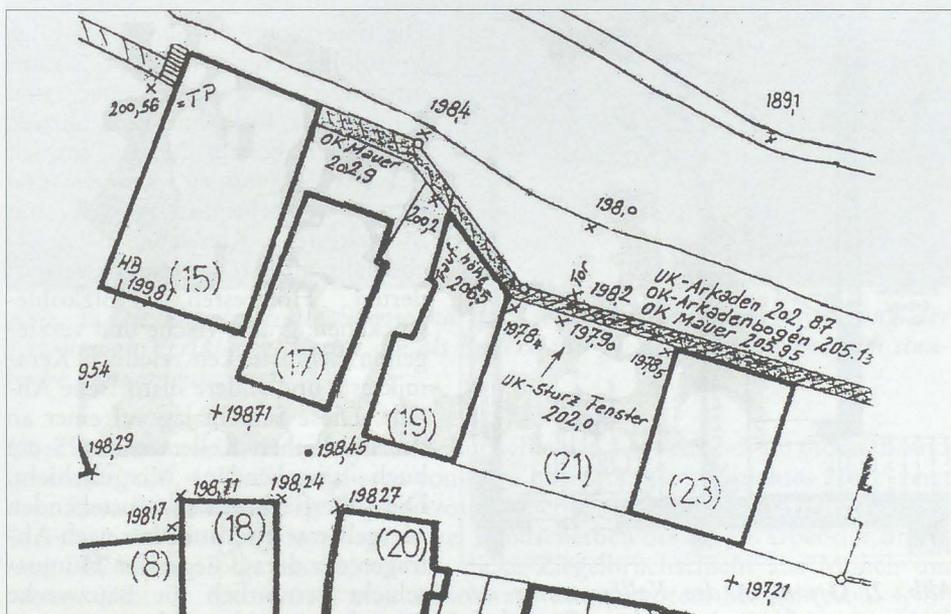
Lageplan des Gebäudes Burgviertel 19 mit Messpunkten.
